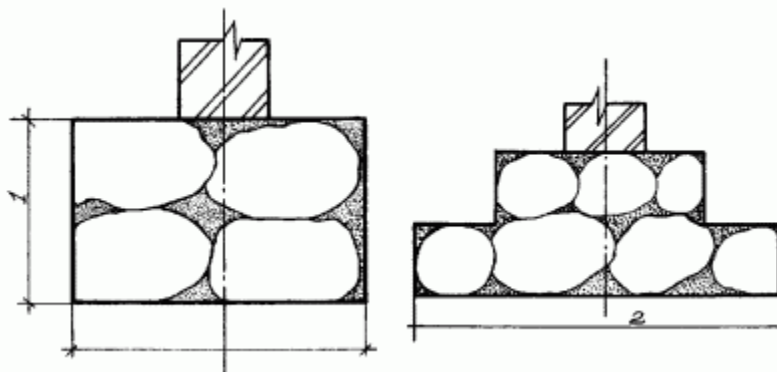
Устройство ленточного фундамента из бутового камня: 1 – глубина заложения фундамента; 2 – ширина подошвы фундамента.
